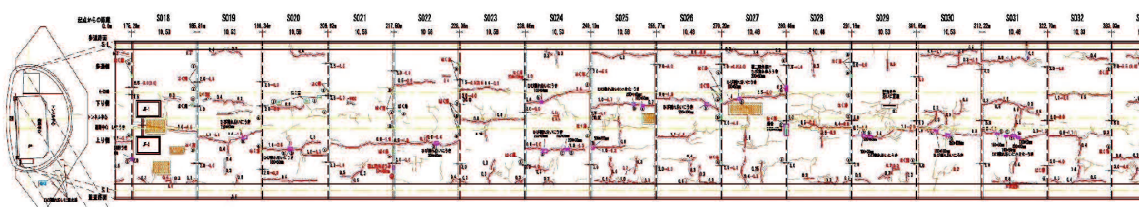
B トンネルの坑内ひび割れ変状箇所⁶⁾
